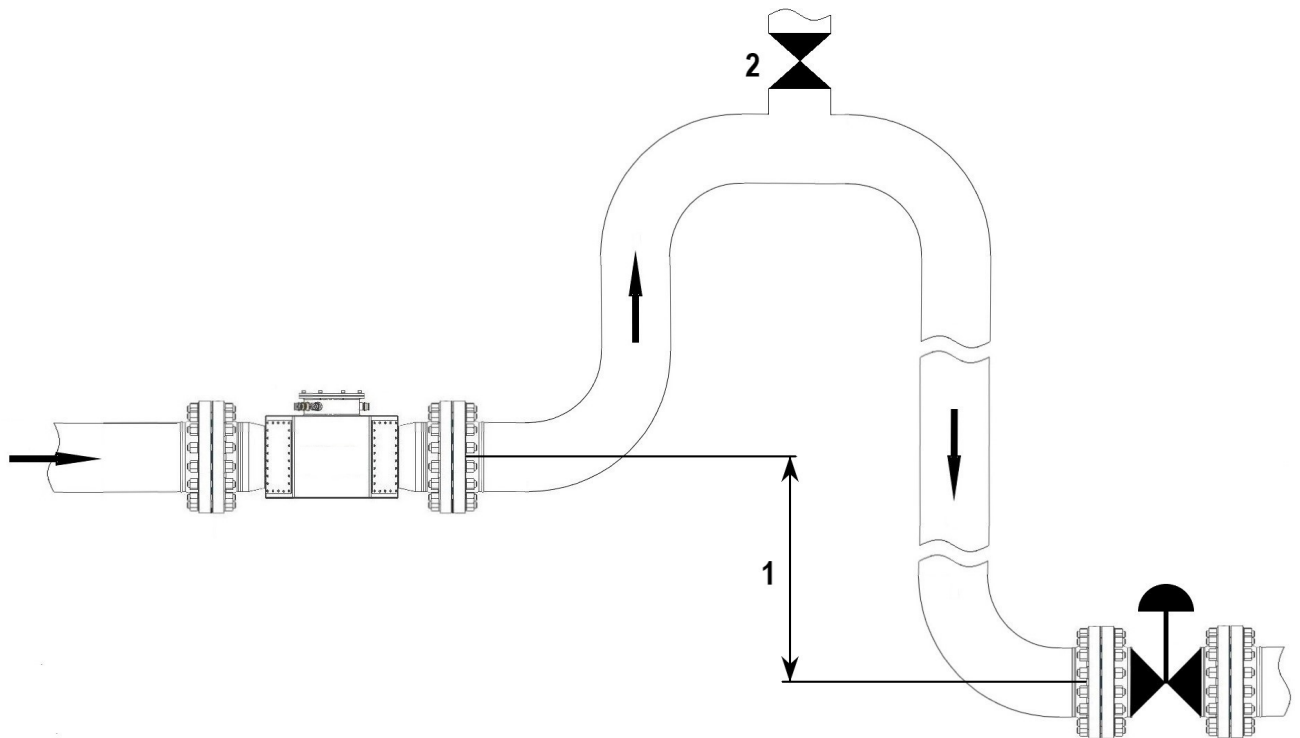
Монтаж на вертикальном трубопроводе перед свободным сливом
